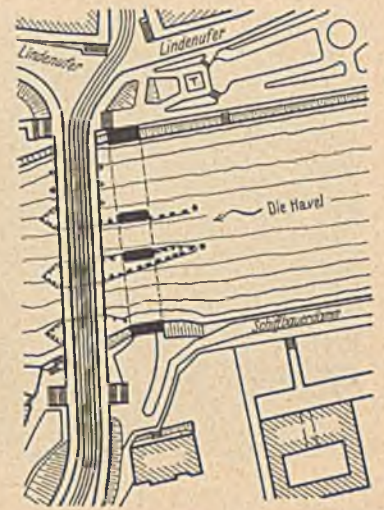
Charlottenbrücke über die Havel in Berlin-Spandau — alte Brückenlage — Lageplan.
